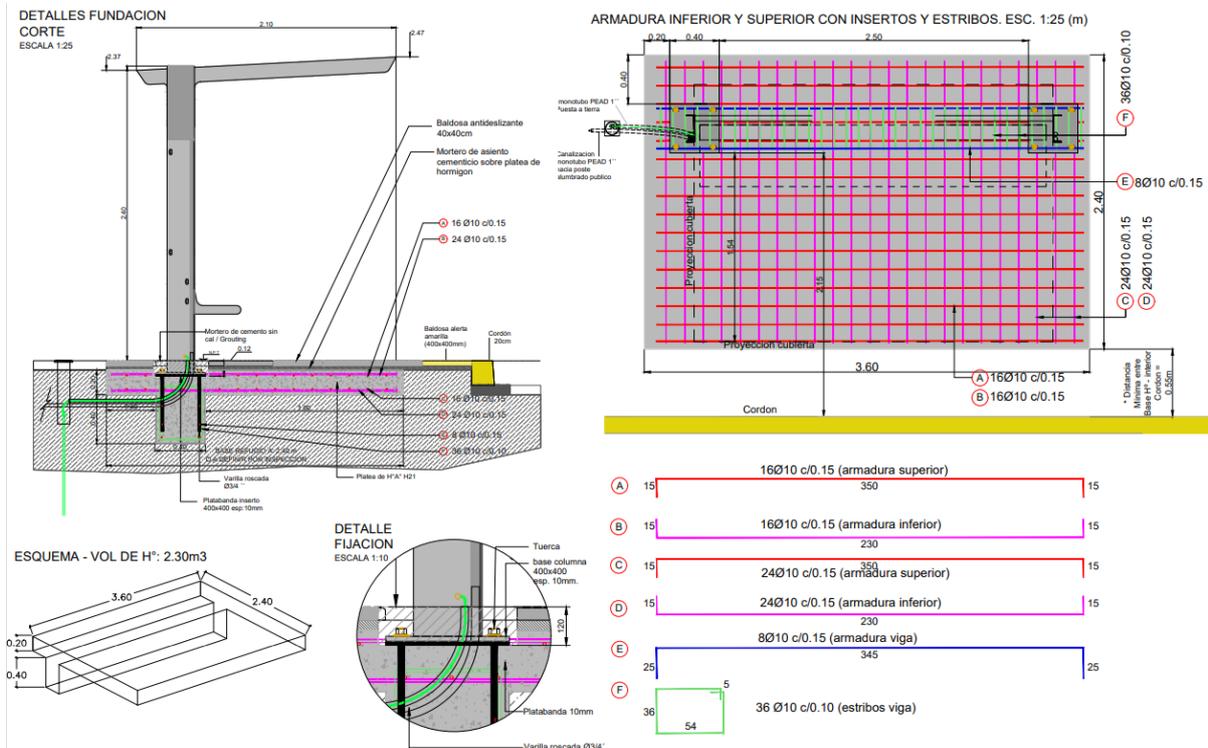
B. – Detalle Constructivo del Refugio Tipo A utilizado por el Ministerio de Obras Públicas de la Nación
